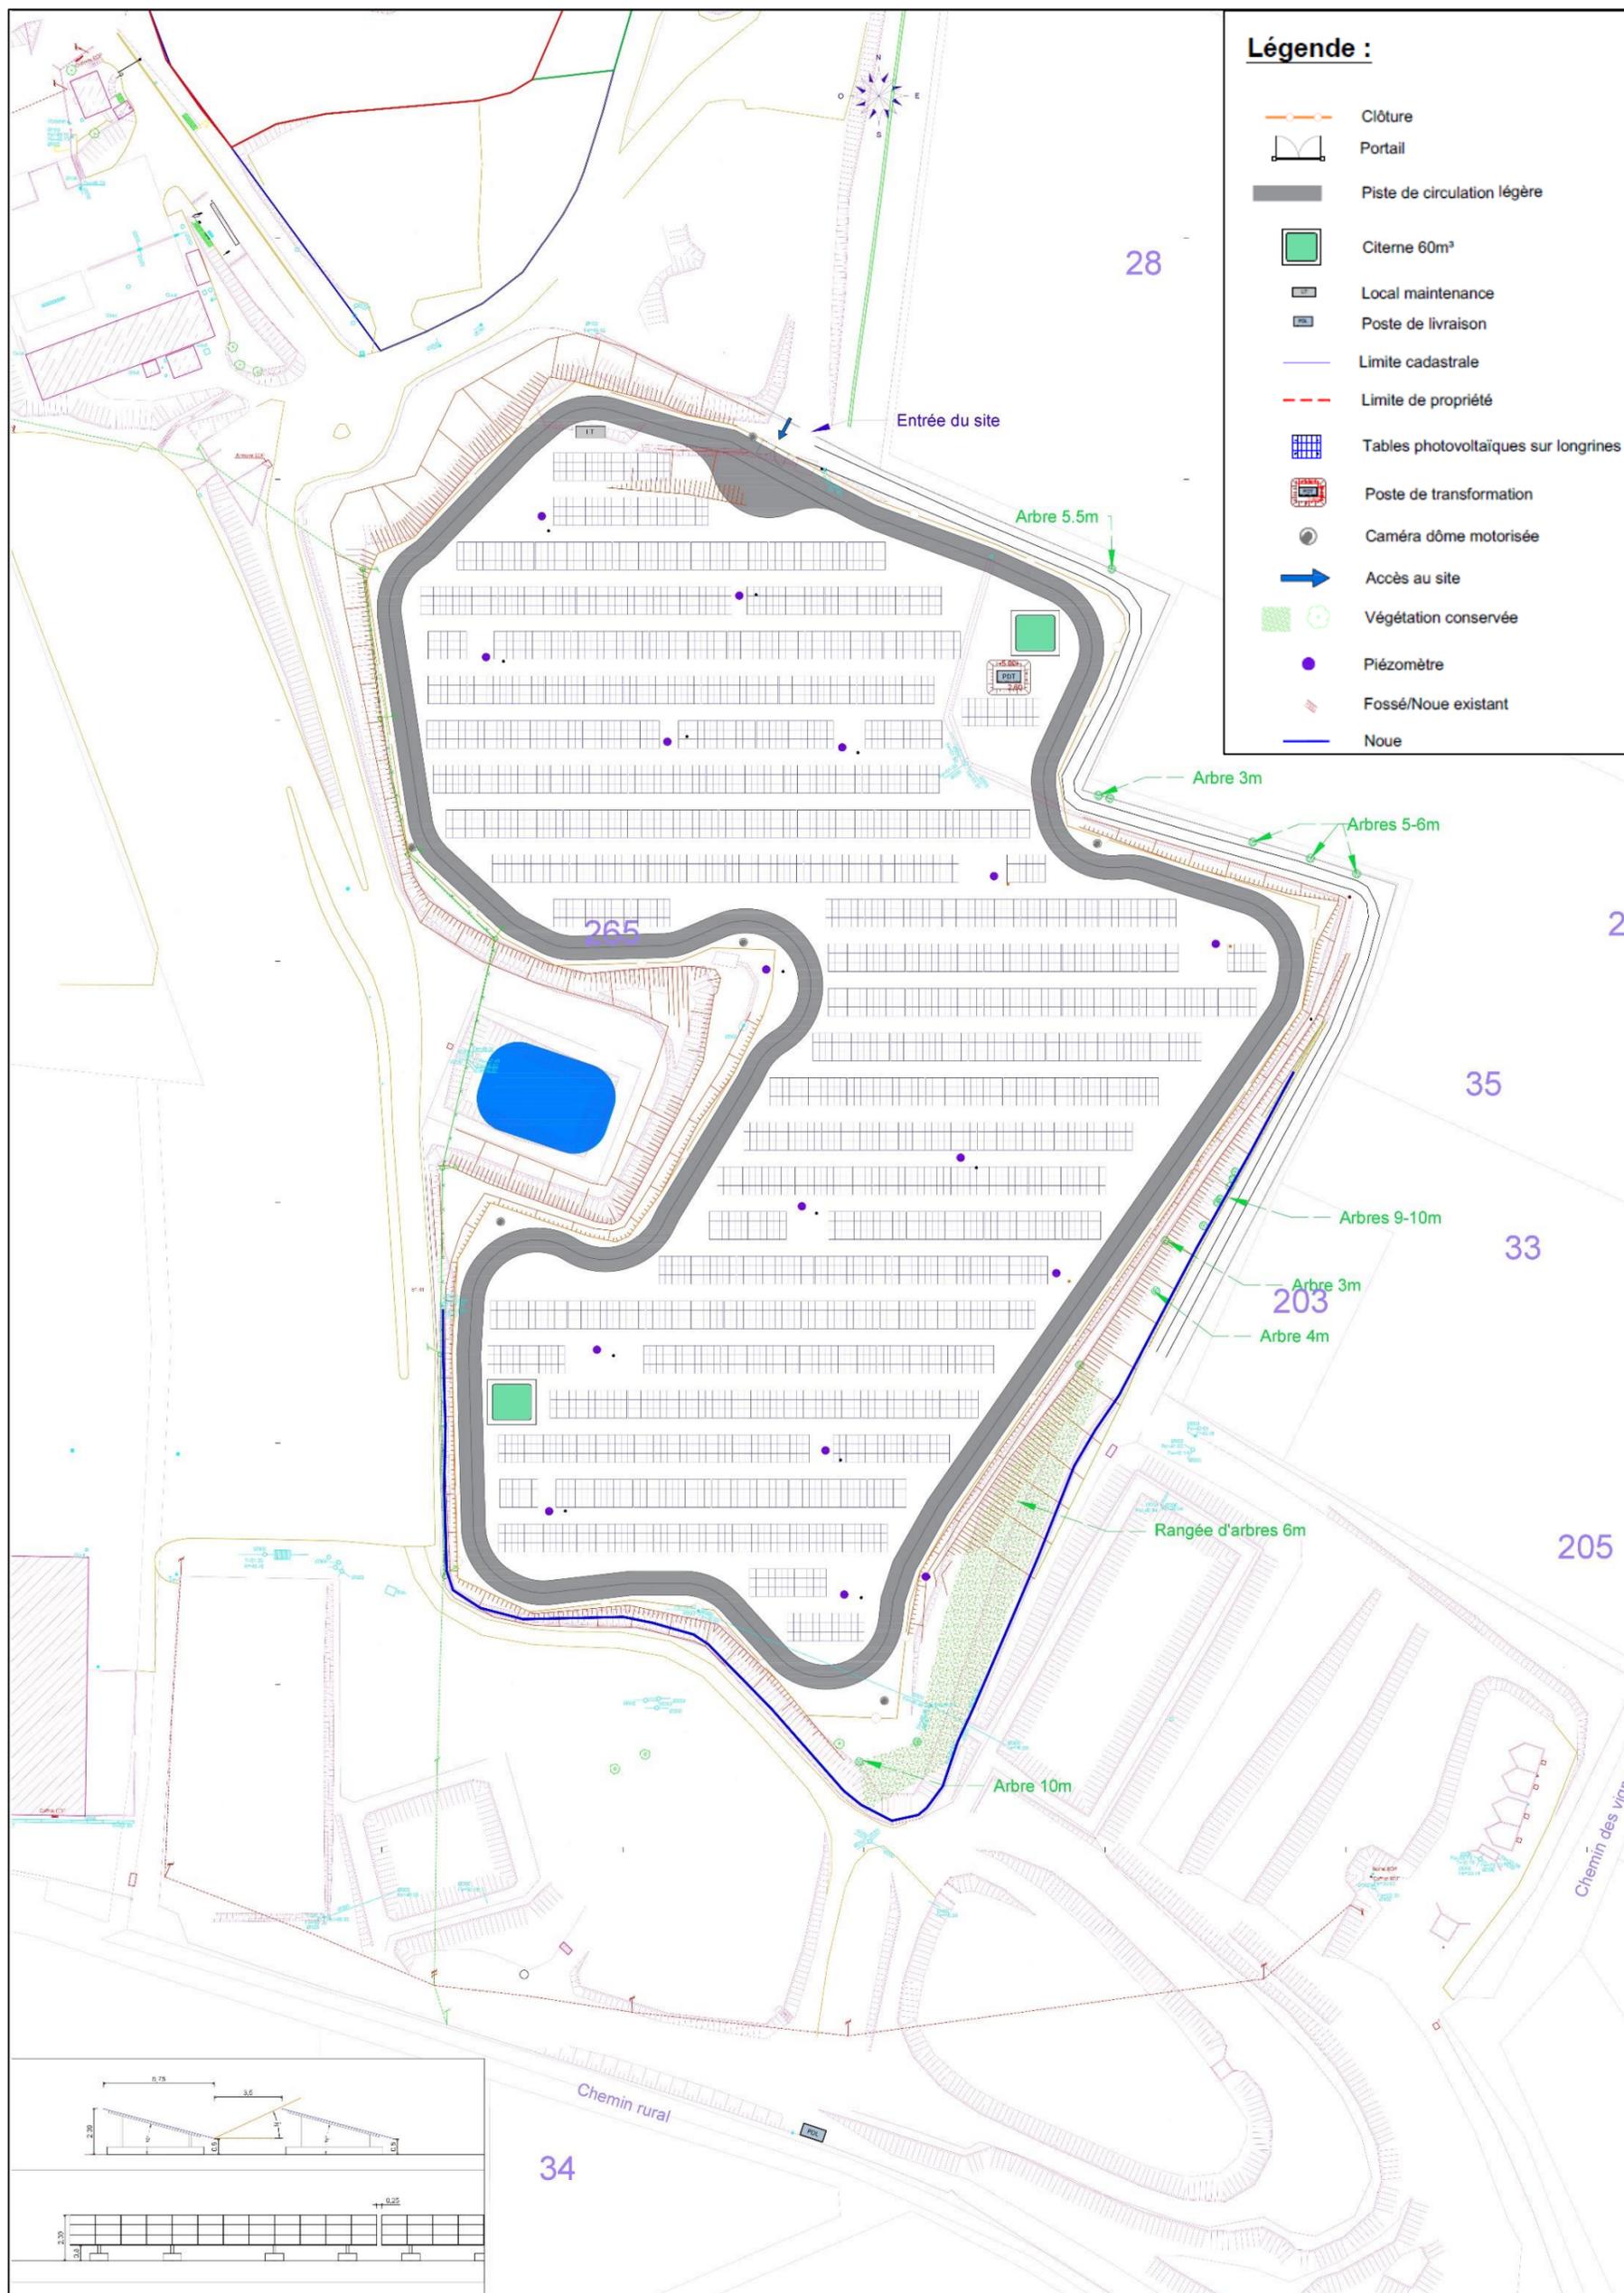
Plan de principe du projet (Source : URBASOLAR)
